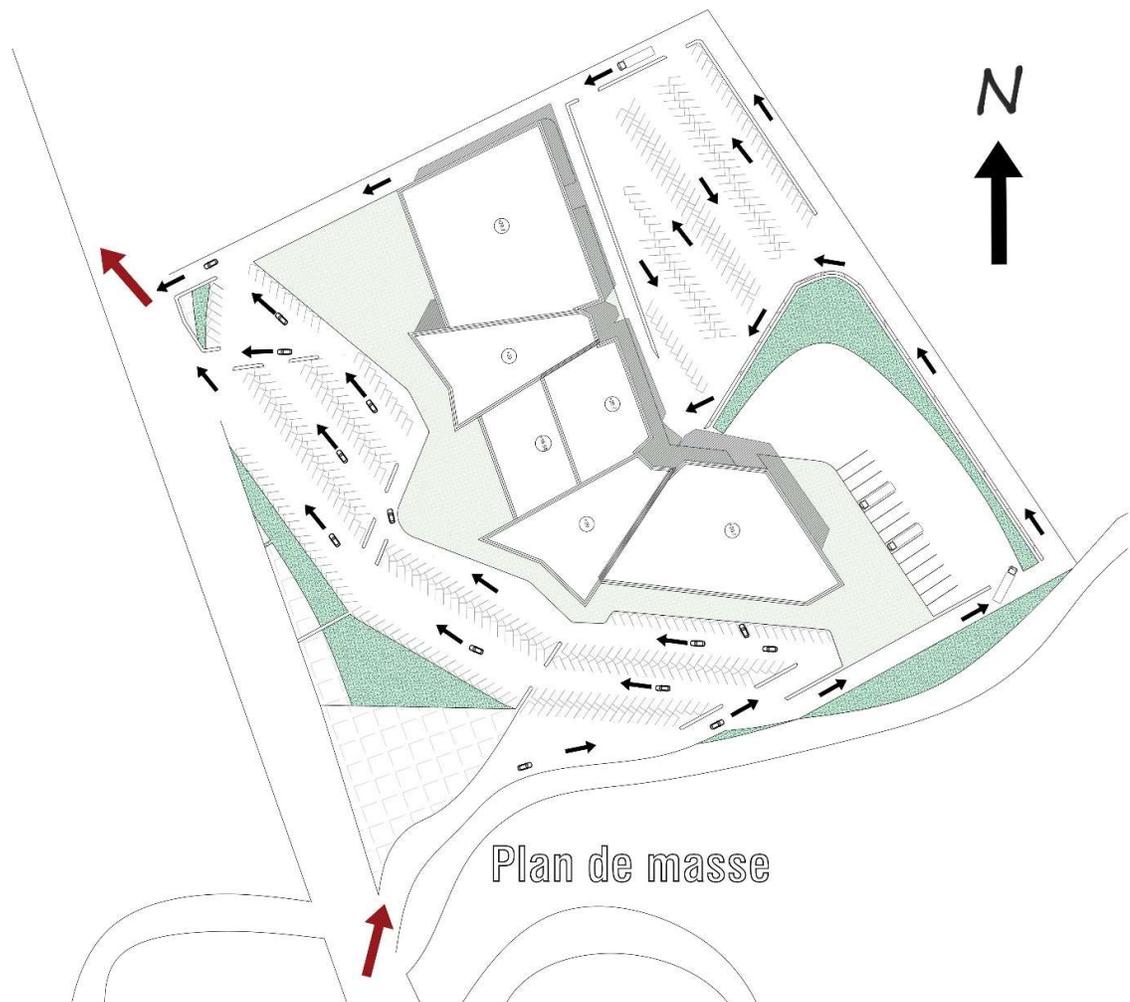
Plan 01: Plan de masse (l'auteur 2020)
